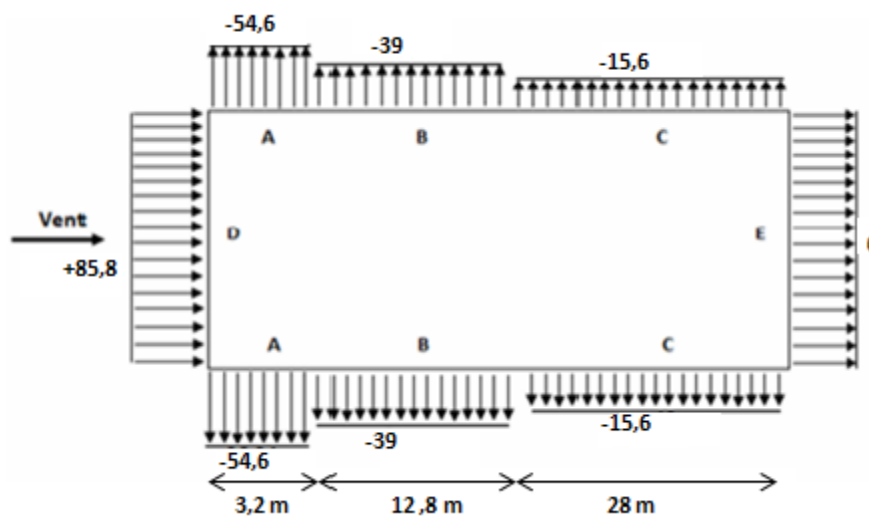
Pressions sur les parois verticales directions du vent (V2,V4) [daN/m²].
